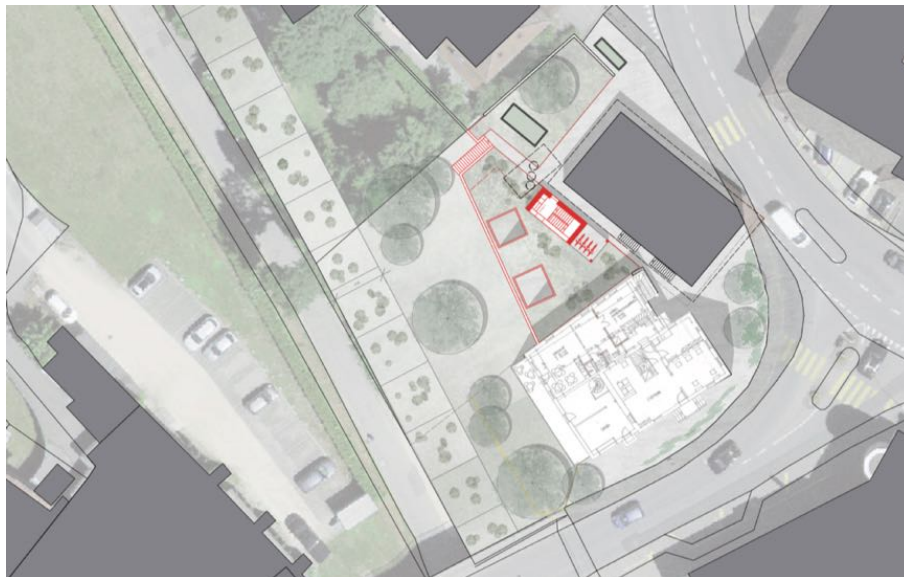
Aussenraumvariante mit Gärten und Bestockung im Stadtgraben
